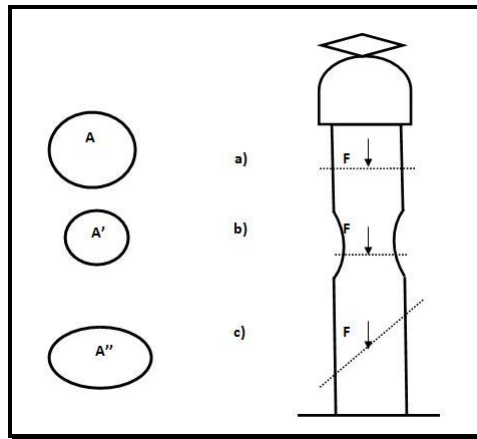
Definición de esfuerzo aplicado en un pilar.
